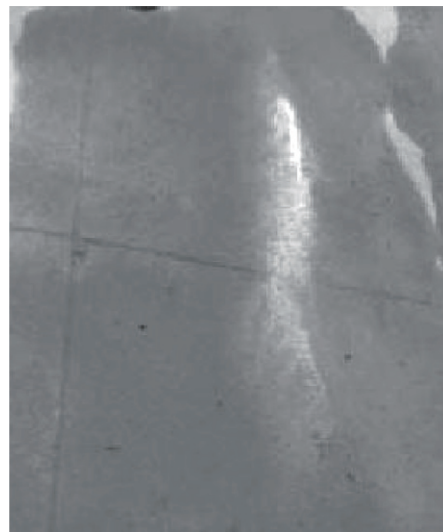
外壁ひび割れ部のエフロレッセンス
